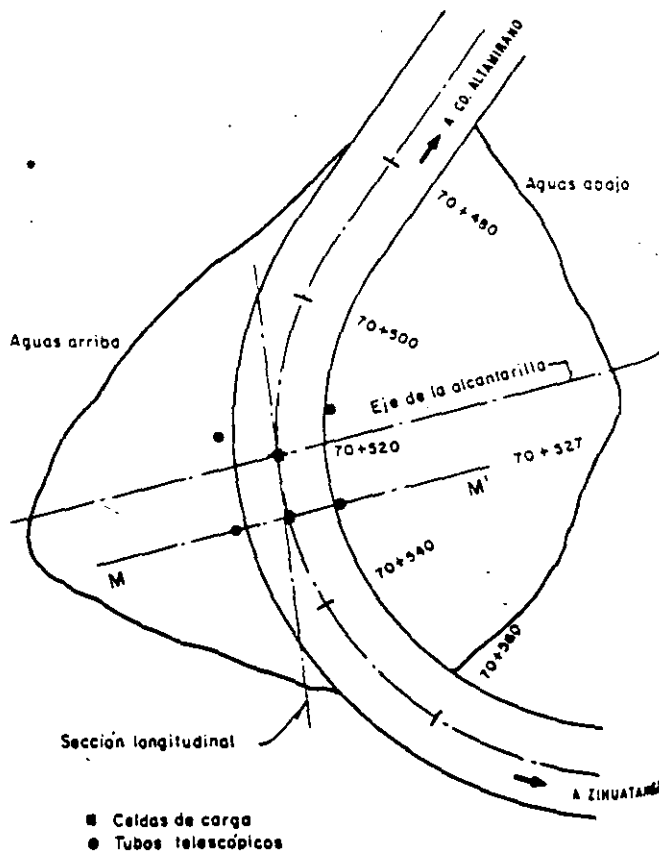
Planta de localización de la instrumentación dispuesta en el pedraplén "La Chachalaca".
